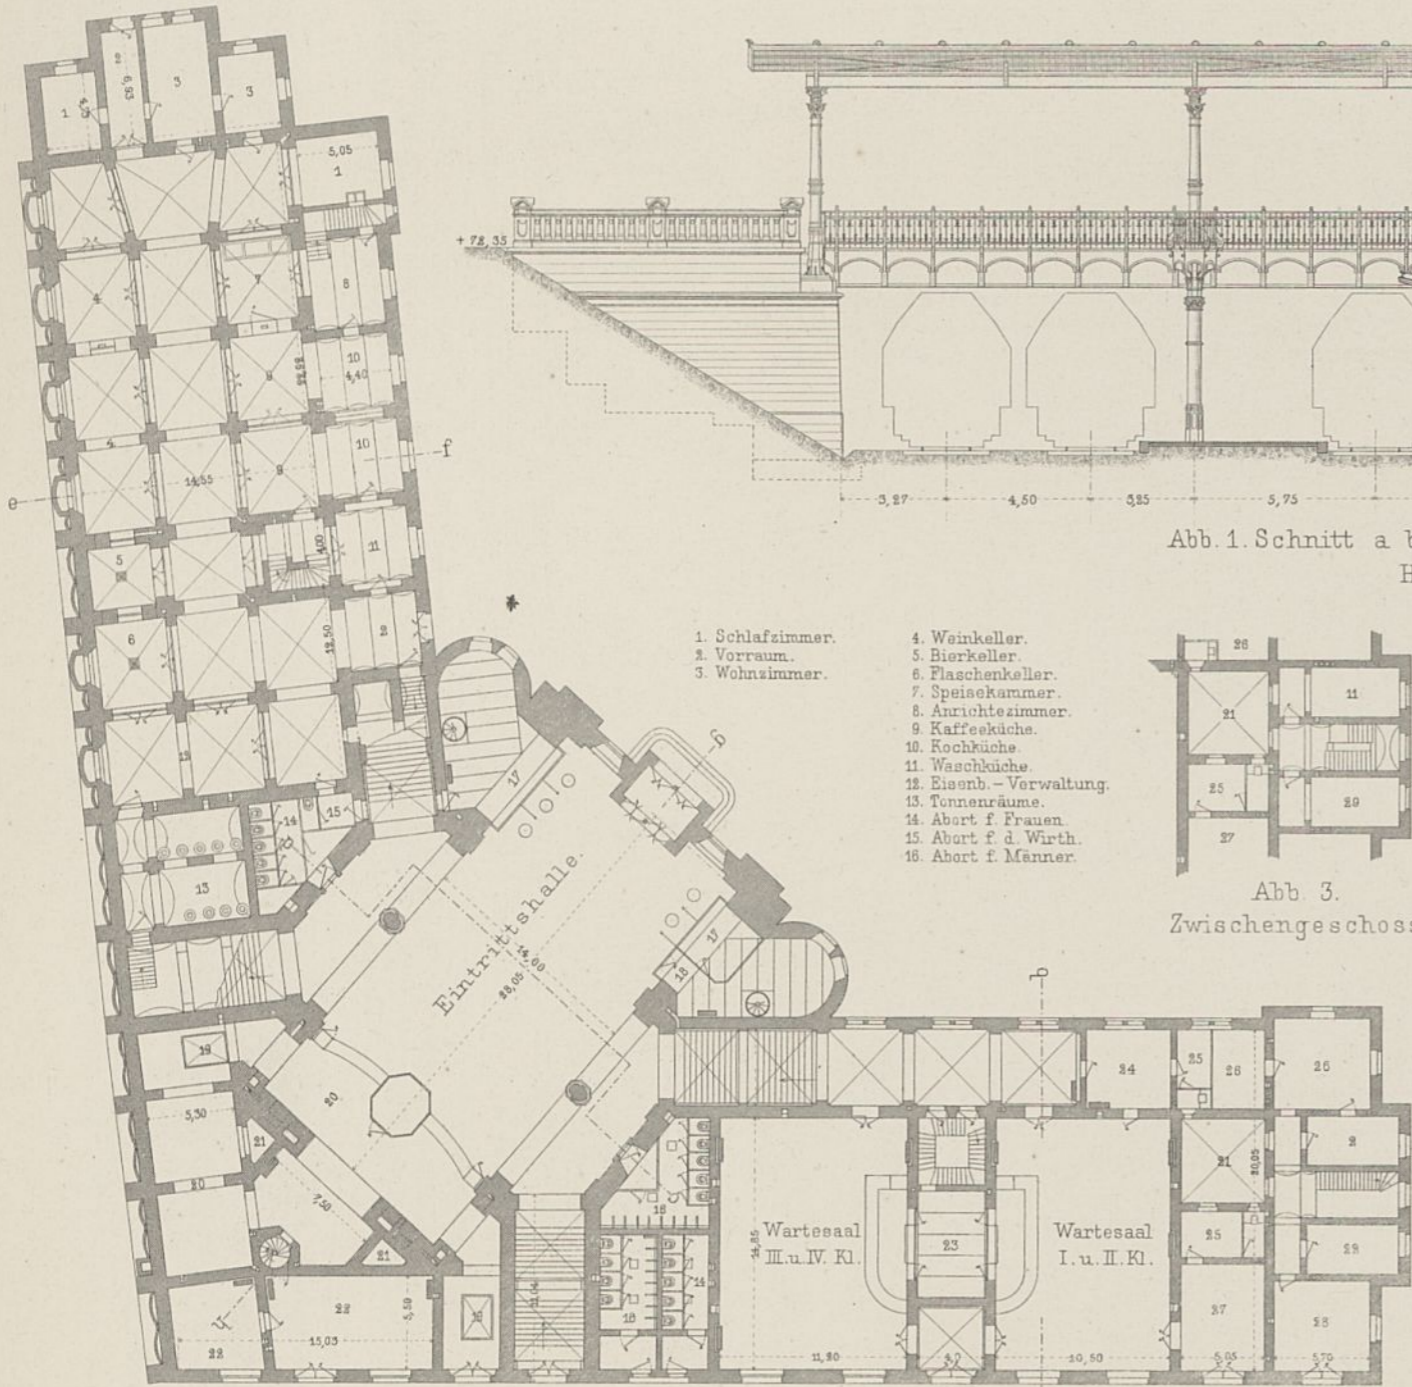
Grundriss in Höhe der Eintrittshalle.
